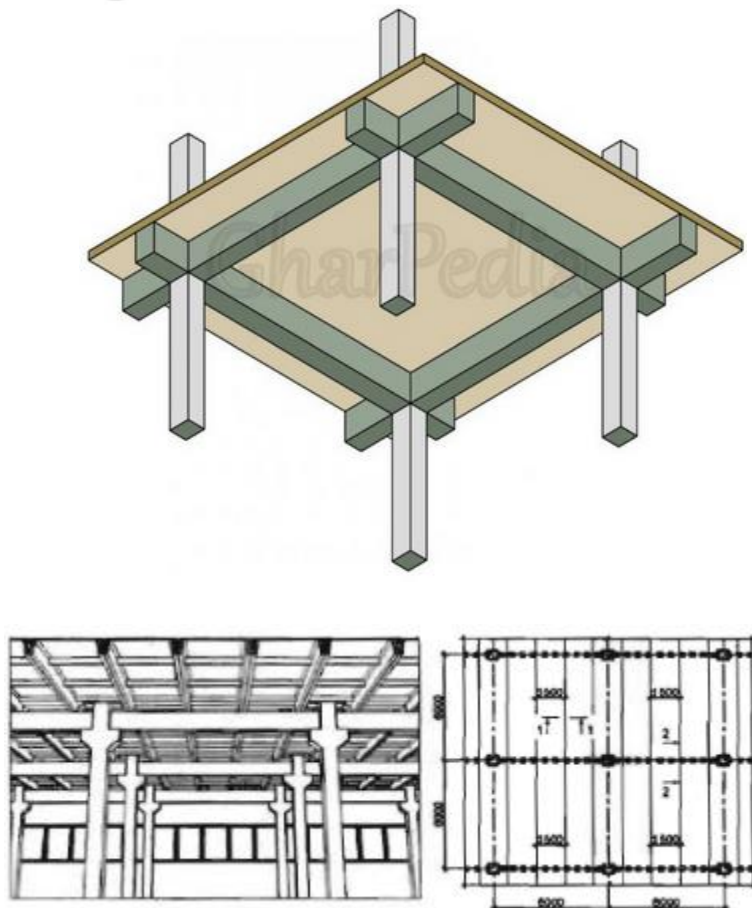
Монолітна залізобетонна плита спирається на балки (ребра) по контуру – а; балочні перекриття багатопверхових виробничих будівель при сітці колон бхб м при спиранні ребристих плит поверх ригелів серія ІІІ-20 – б.
